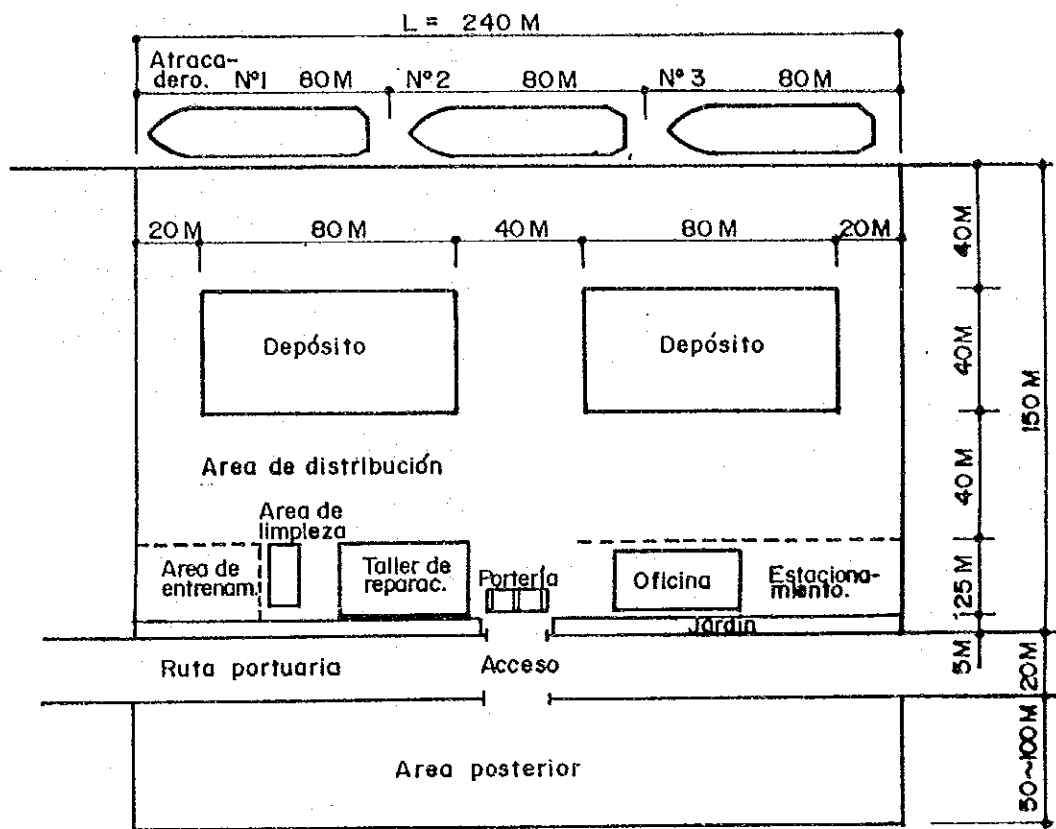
EQUIPAMIENTO DE ATRACADERO DE CARGA BRUTA
